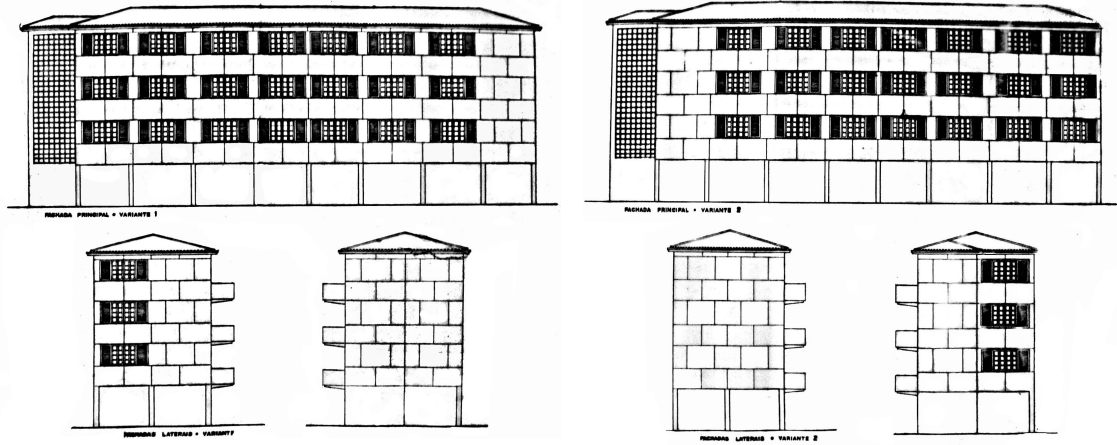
Fachadas frontais e laterais Tipologias J1/J2 e I2. Fonte: arquivo INSS.
